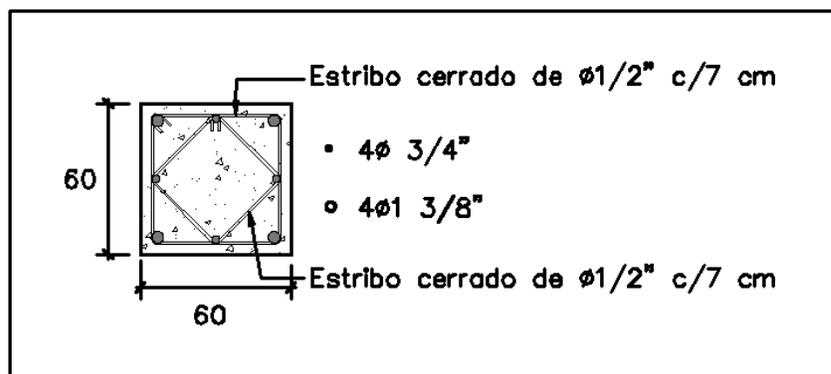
Detallado para CM1 aplicando los requisitos de confinamiento de ACI 318-14.
